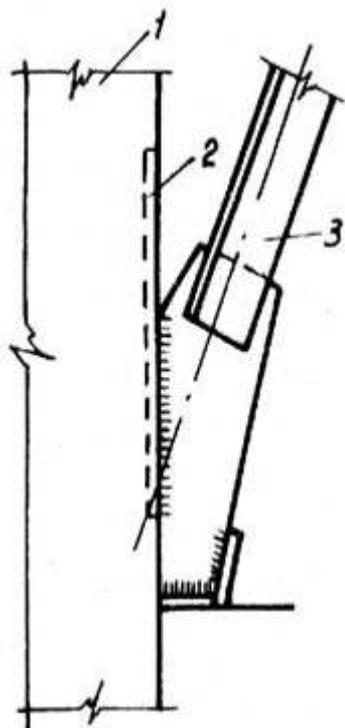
Схема дефектного примыкания вертикальной связи к колонне при смещении закладной детали в ней:
